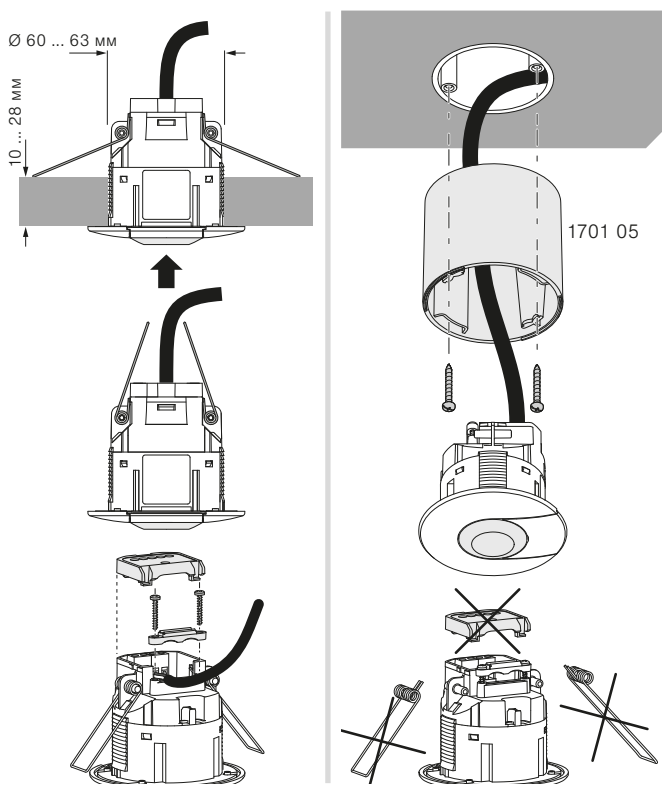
Монтаж в подвесной потолок или в коробку для наружного монтажа 1701 05
